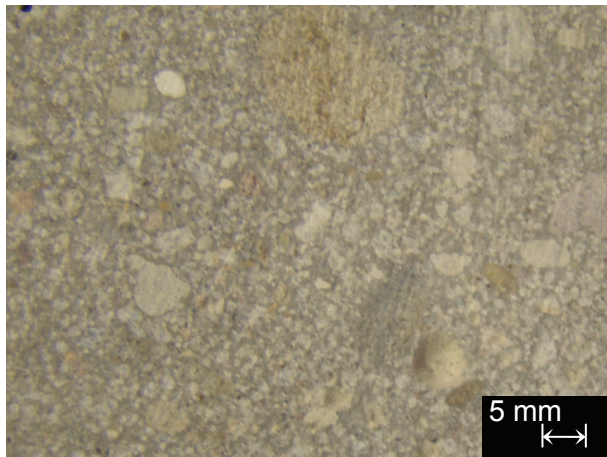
Plangefräste Betonoberfläche vorbereitet für die Beschichtung mit KFV
